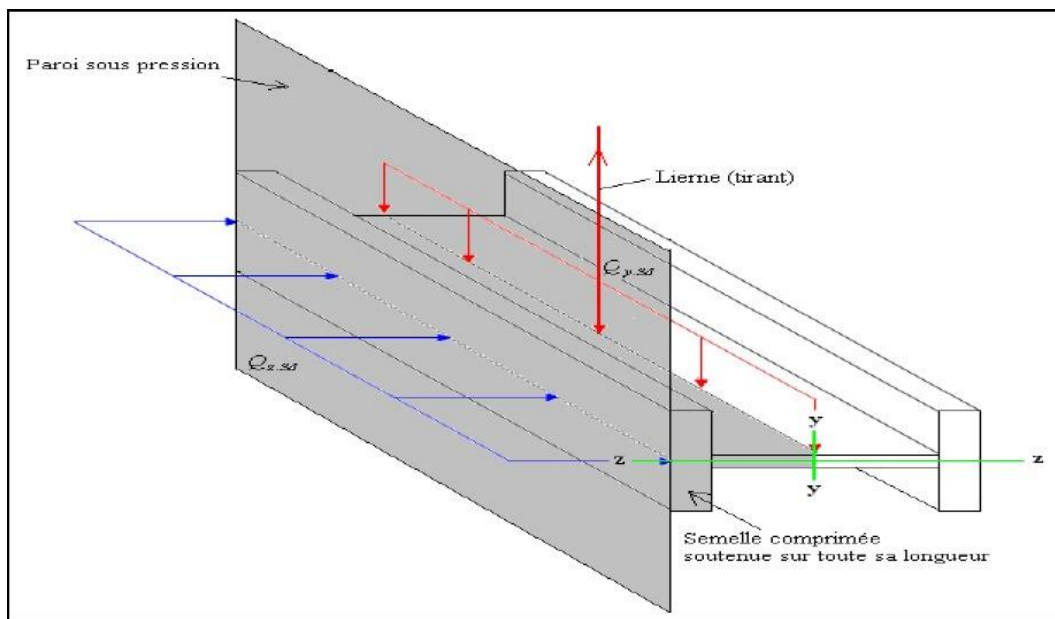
Semelle comprimée soutenue sur toute sa longueur
